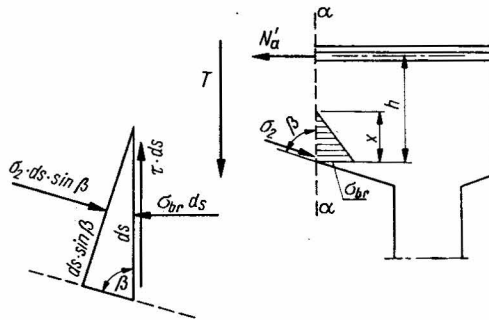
Contraintes dans une section verticale d'une poutre munie de goussets sur l'appui
